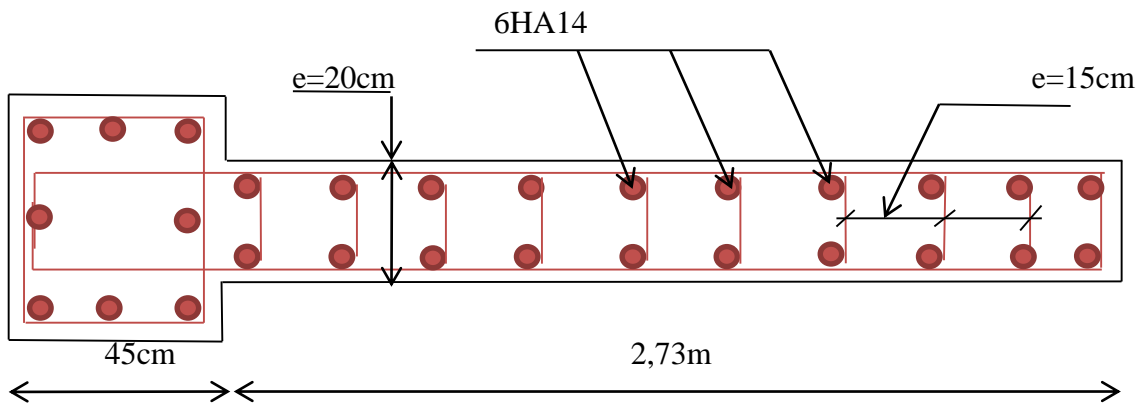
Coupe horizontale de ferrailage des voiles(VL2) ou niveau RDC
